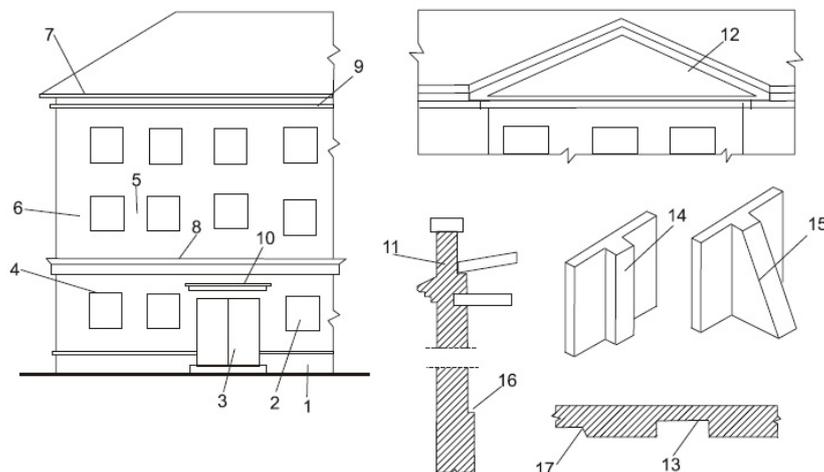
Архитектурно-конструктивные компоненты стен: 1 — цоколь; 2 — оконный проем; 3 — дверной проем; 4 — перемычки; 5 — простенок рядовой; 6 — то же, угловой; 7 — карниз венчающий; 8 — то же, промежуточный; 9 — поясок; 10 — сандрик; 11 — парапет; 12 — фронтон; 13 — ниша; 14 — пилястра; 15 — контрфорс; 16 — обрез; 17 — раскреповка
